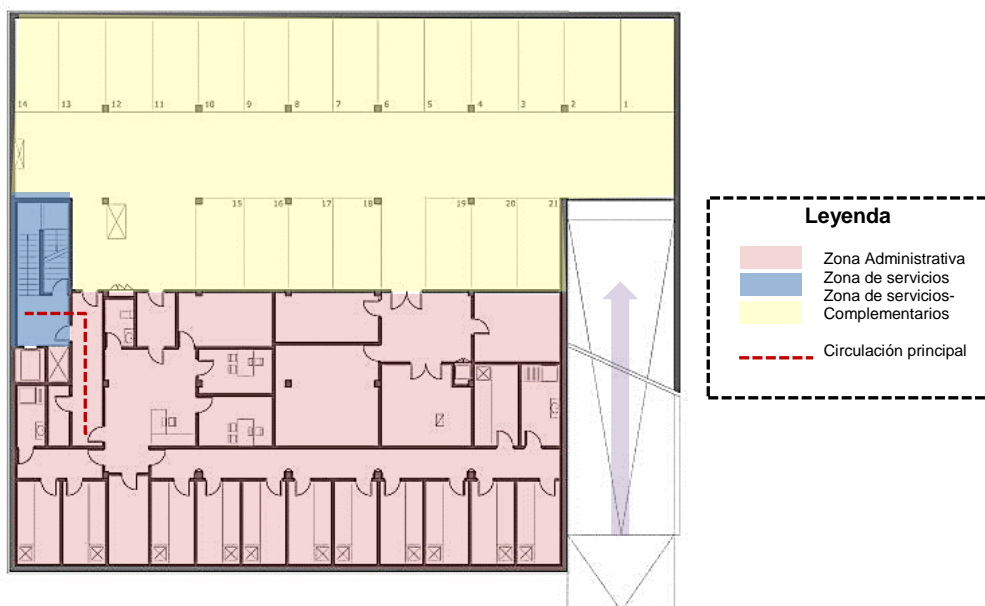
Planta sótano comisaría Mossos-Barcelona
